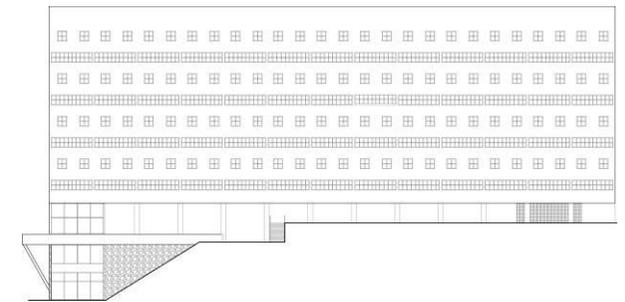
Conjunto Residencial Vila Isabel, fachada como foi executada
